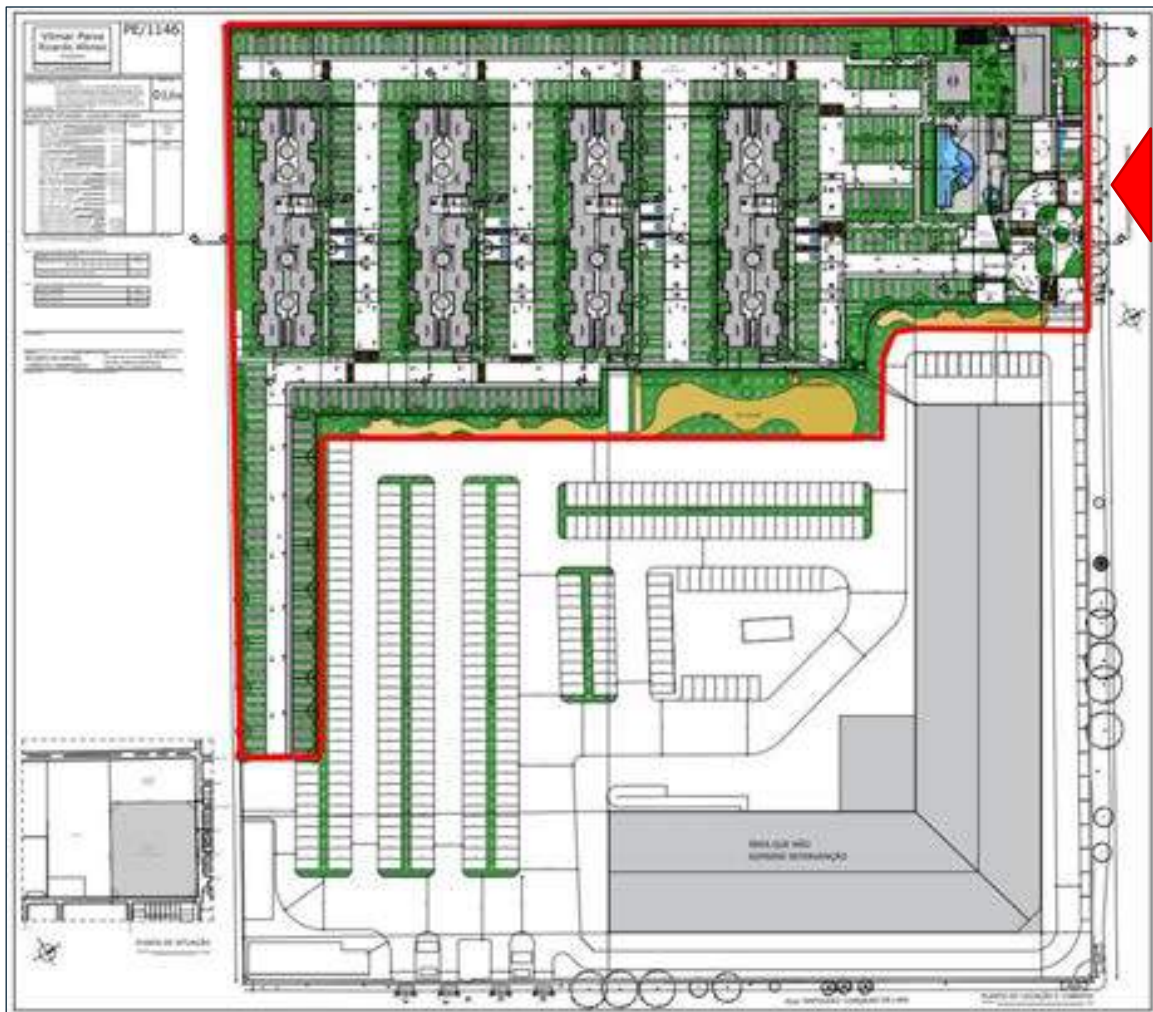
Demonstração da testada do empreendimento na Avenida Transamazônica, conforme projeto arquitetônico. Fonte: Arquitetura Vilmar Paiva e Ricardo Afonso - adaptação ONE (2023).
